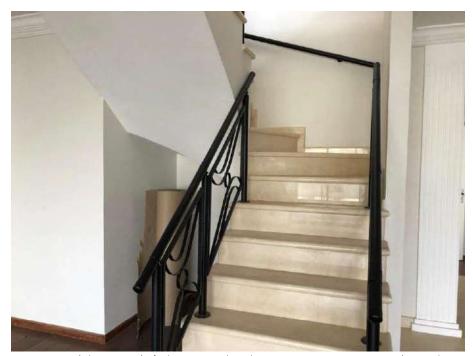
Vista parcial da escada de acesso para o pavimento superior.
